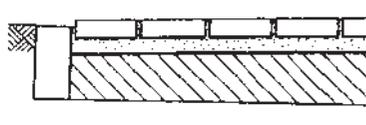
Borde hundido. Aproximadamente unos 2 cm bajo la superficie del pavimento.
